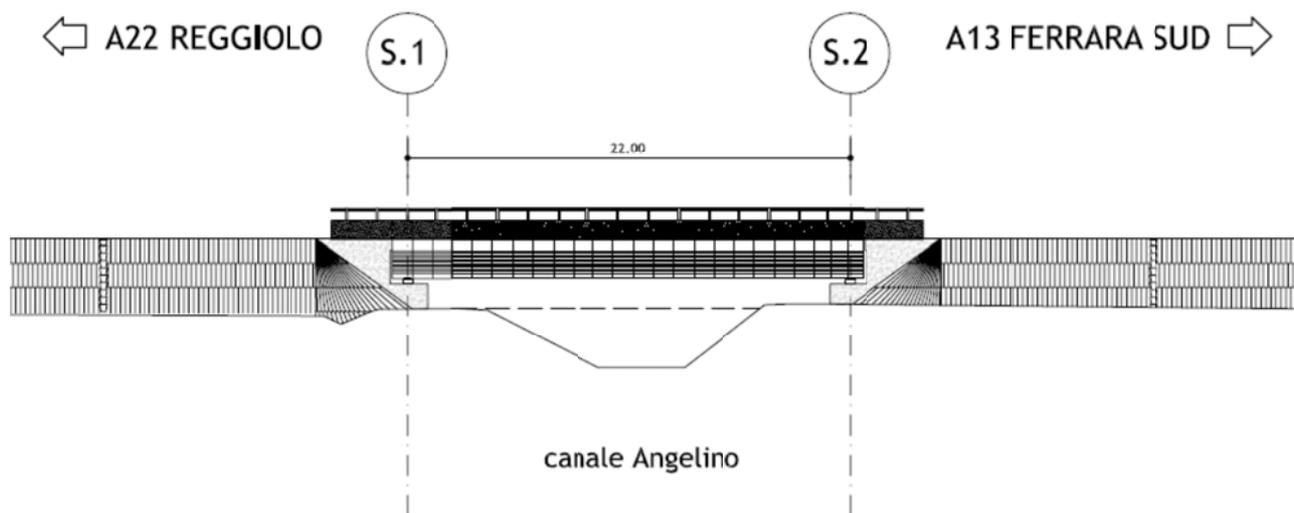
B – PROSPETTO DEL PONTE SUL CAVO ANGELINO (PP)
